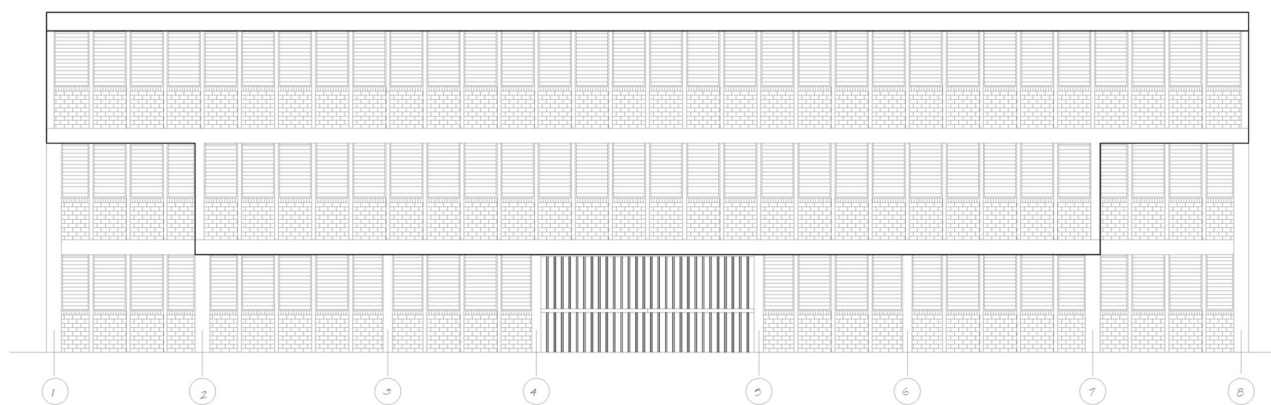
Planos Arquitectónicos – Fachada Principal.
